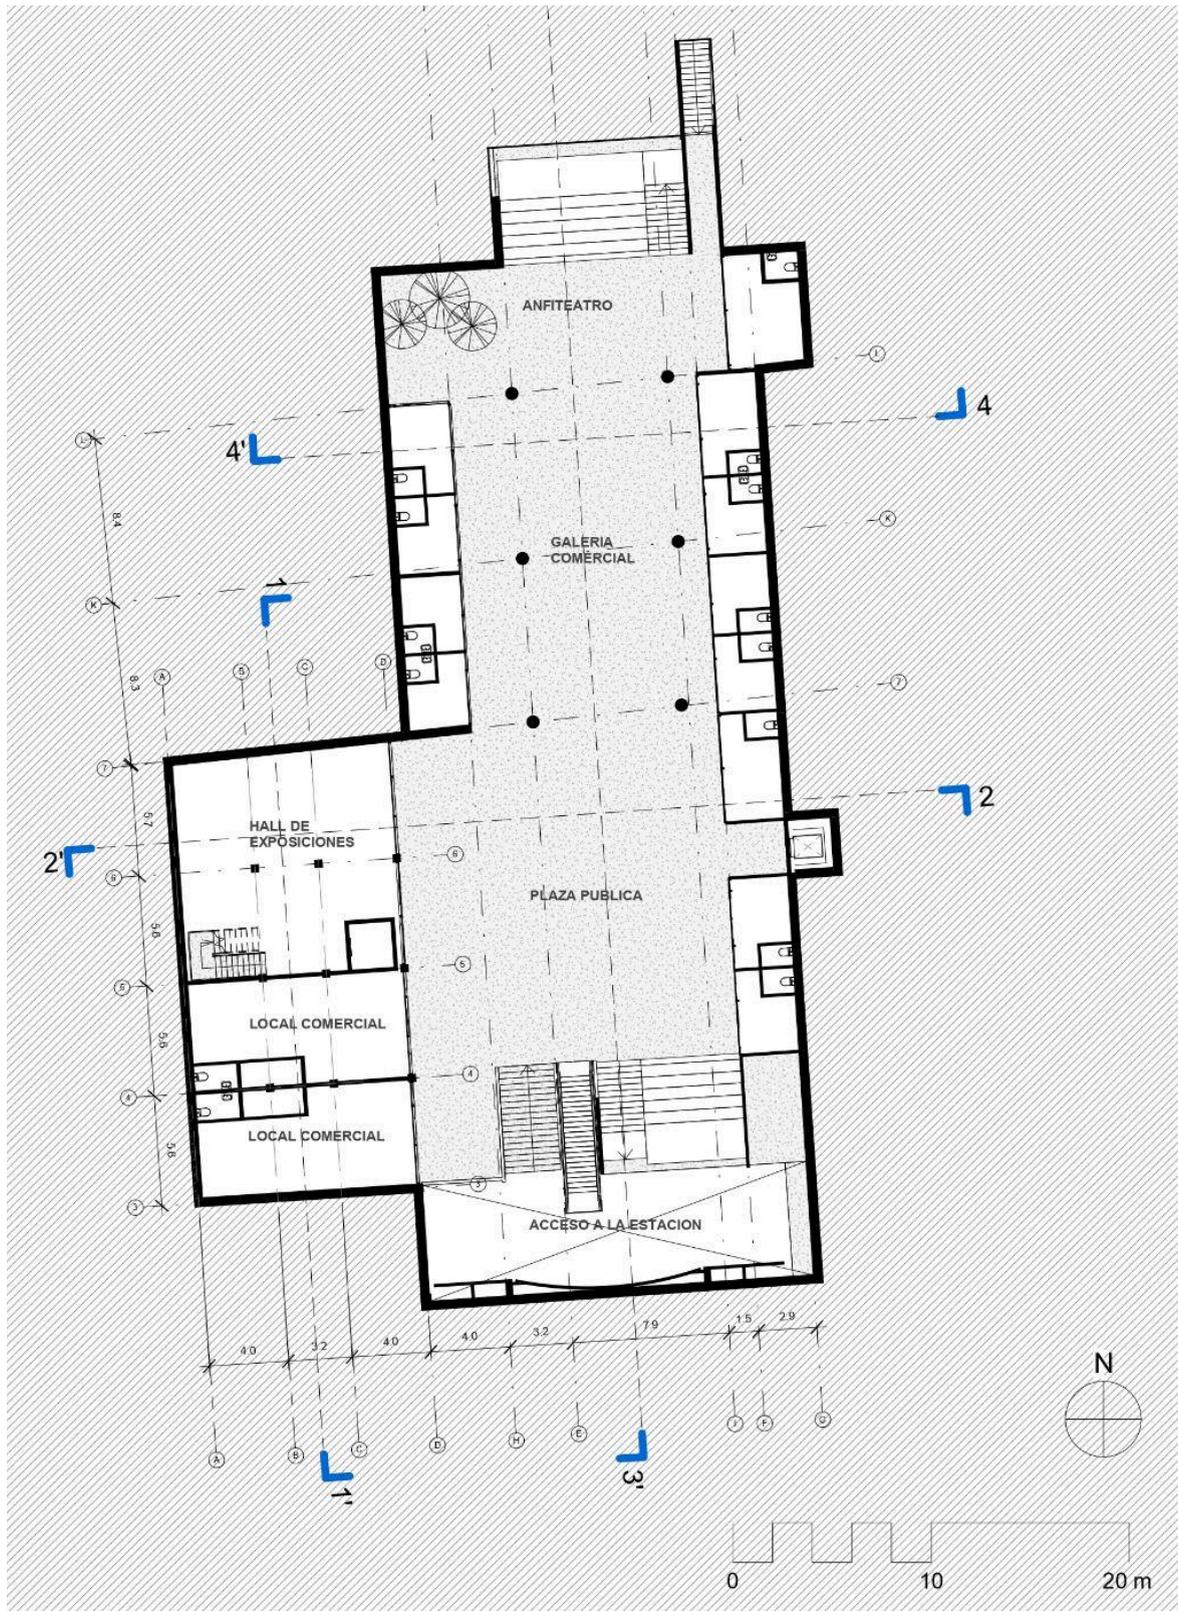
Planta nivel -1. Fuente: Elaboración propia.
